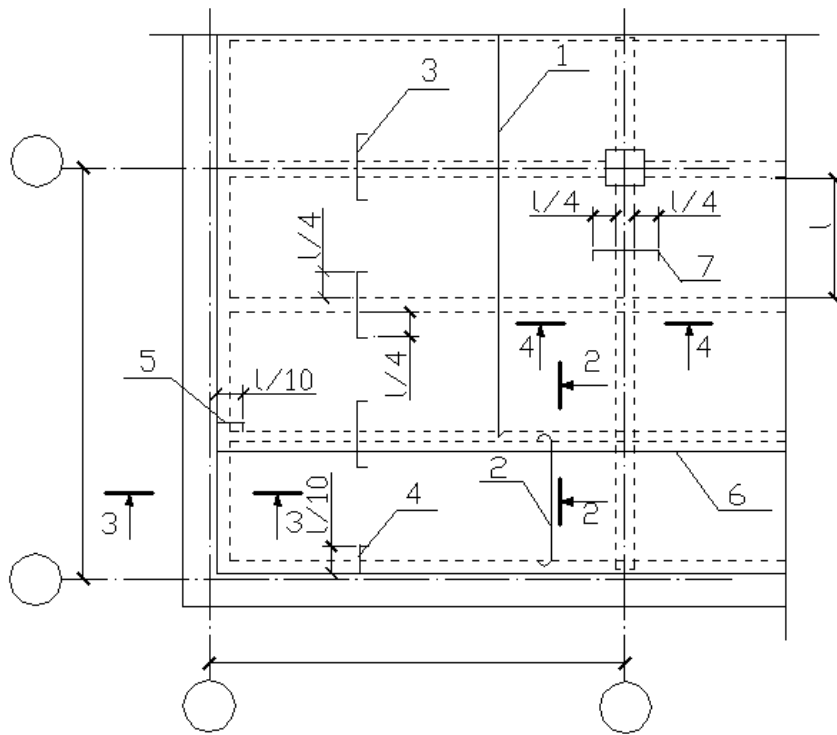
Фрагмент плана перекрытия со схемой армирования
